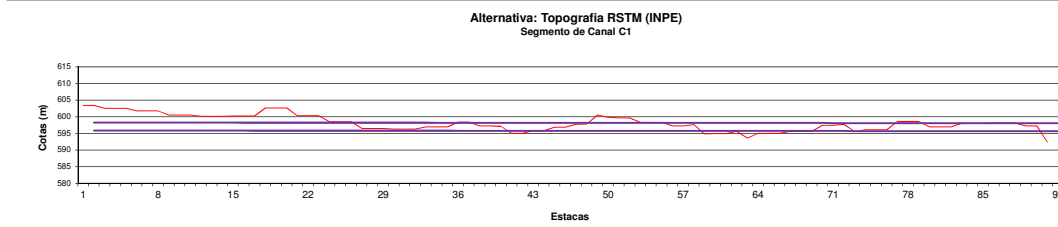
Perfil longitudinal – Segmento de Canal C1 – Traçado alternativo (RSTM/INPE)
